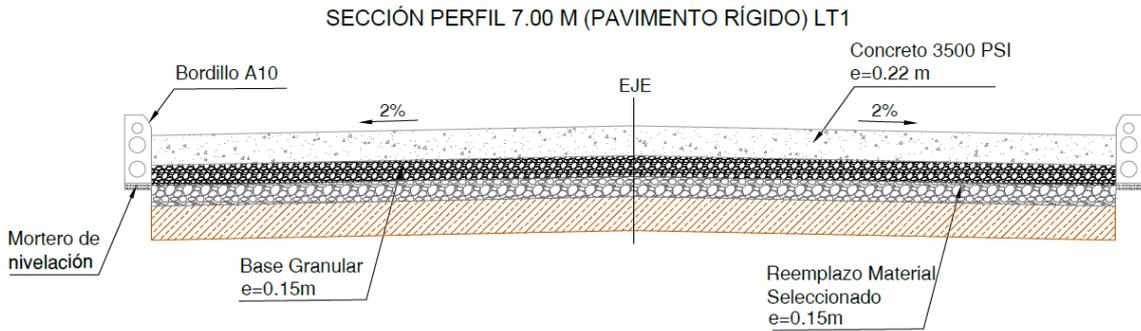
Sección Transversal de la estructura de pavimento. Elaboración Propia
